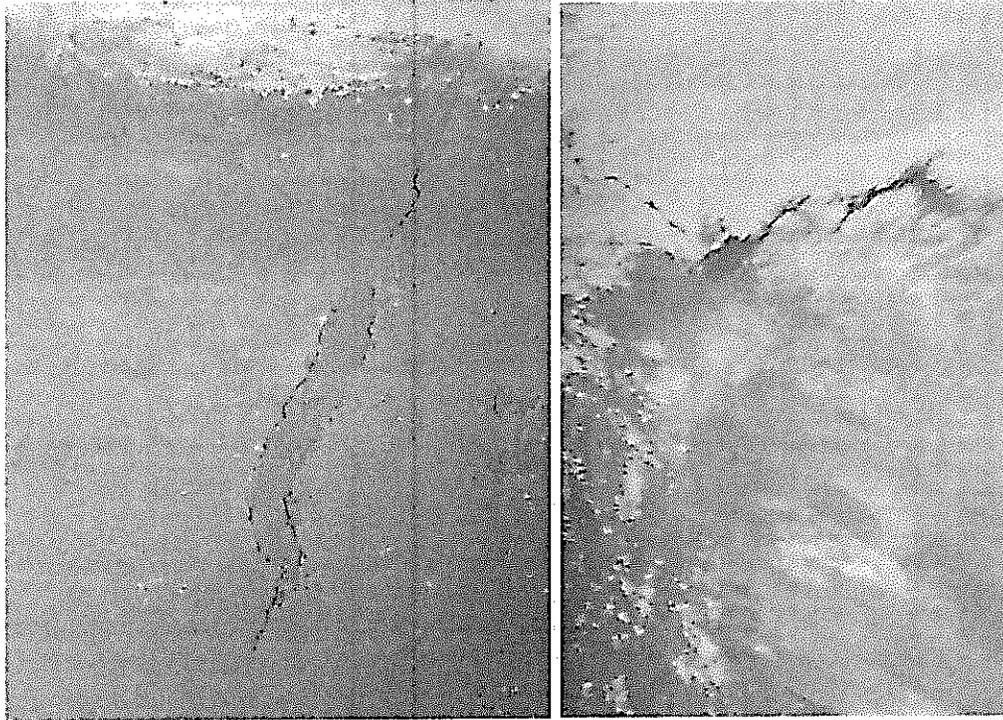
(Izq) Grieta vertical compartida en muro bypass con reparación locativa "revoque". "fuente propia". (Der) fisura lateral en muro.
